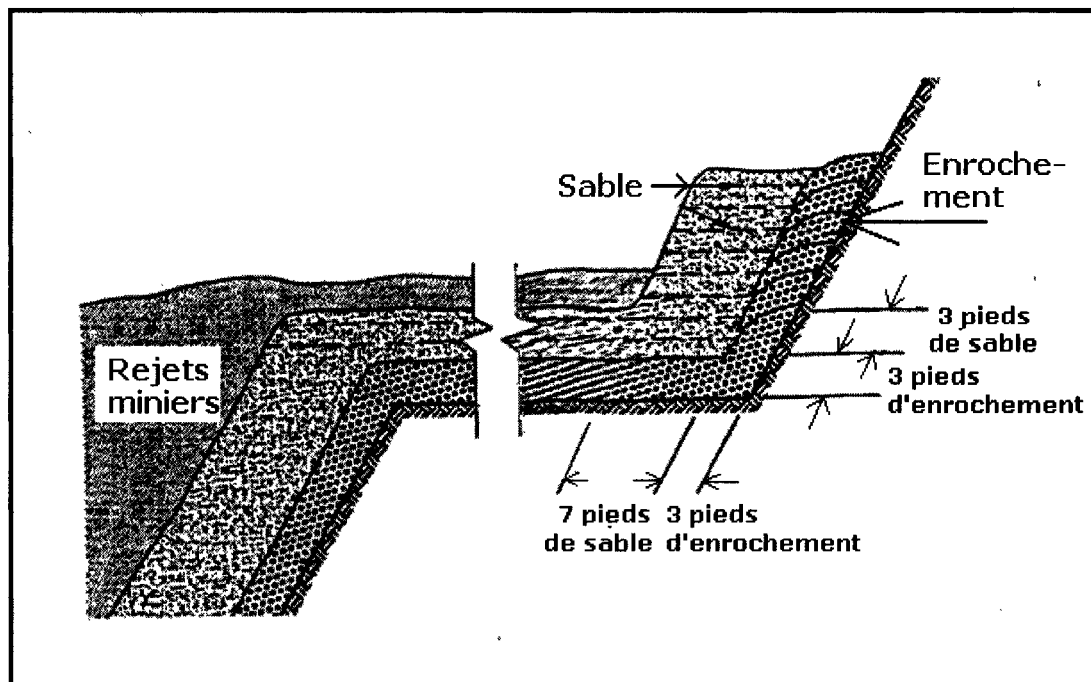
Vue en section de l'enveloppe perméable utilisée au site Rabbit Lake (tirée de Belfadhel, 2000).
